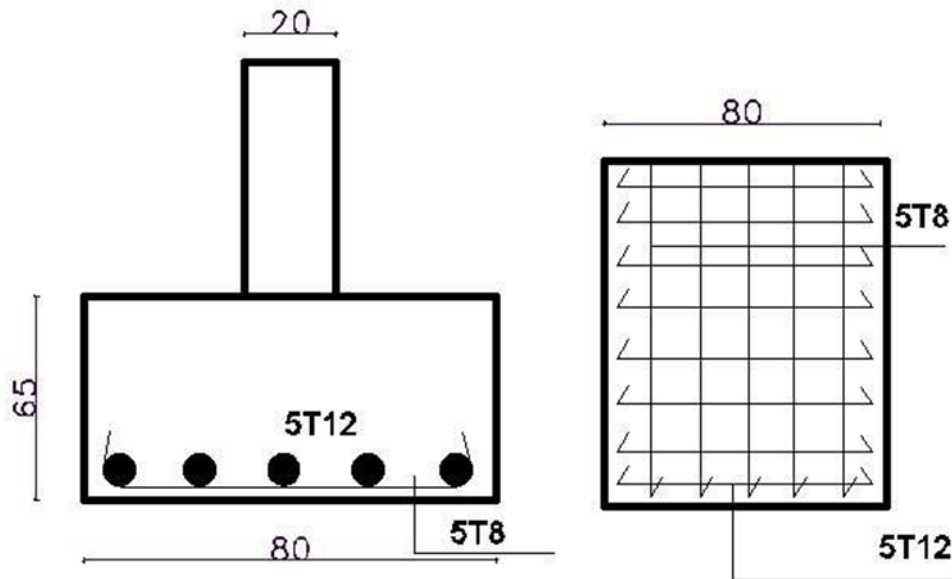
Schéma de ferrailage pour la semelle de voile.
